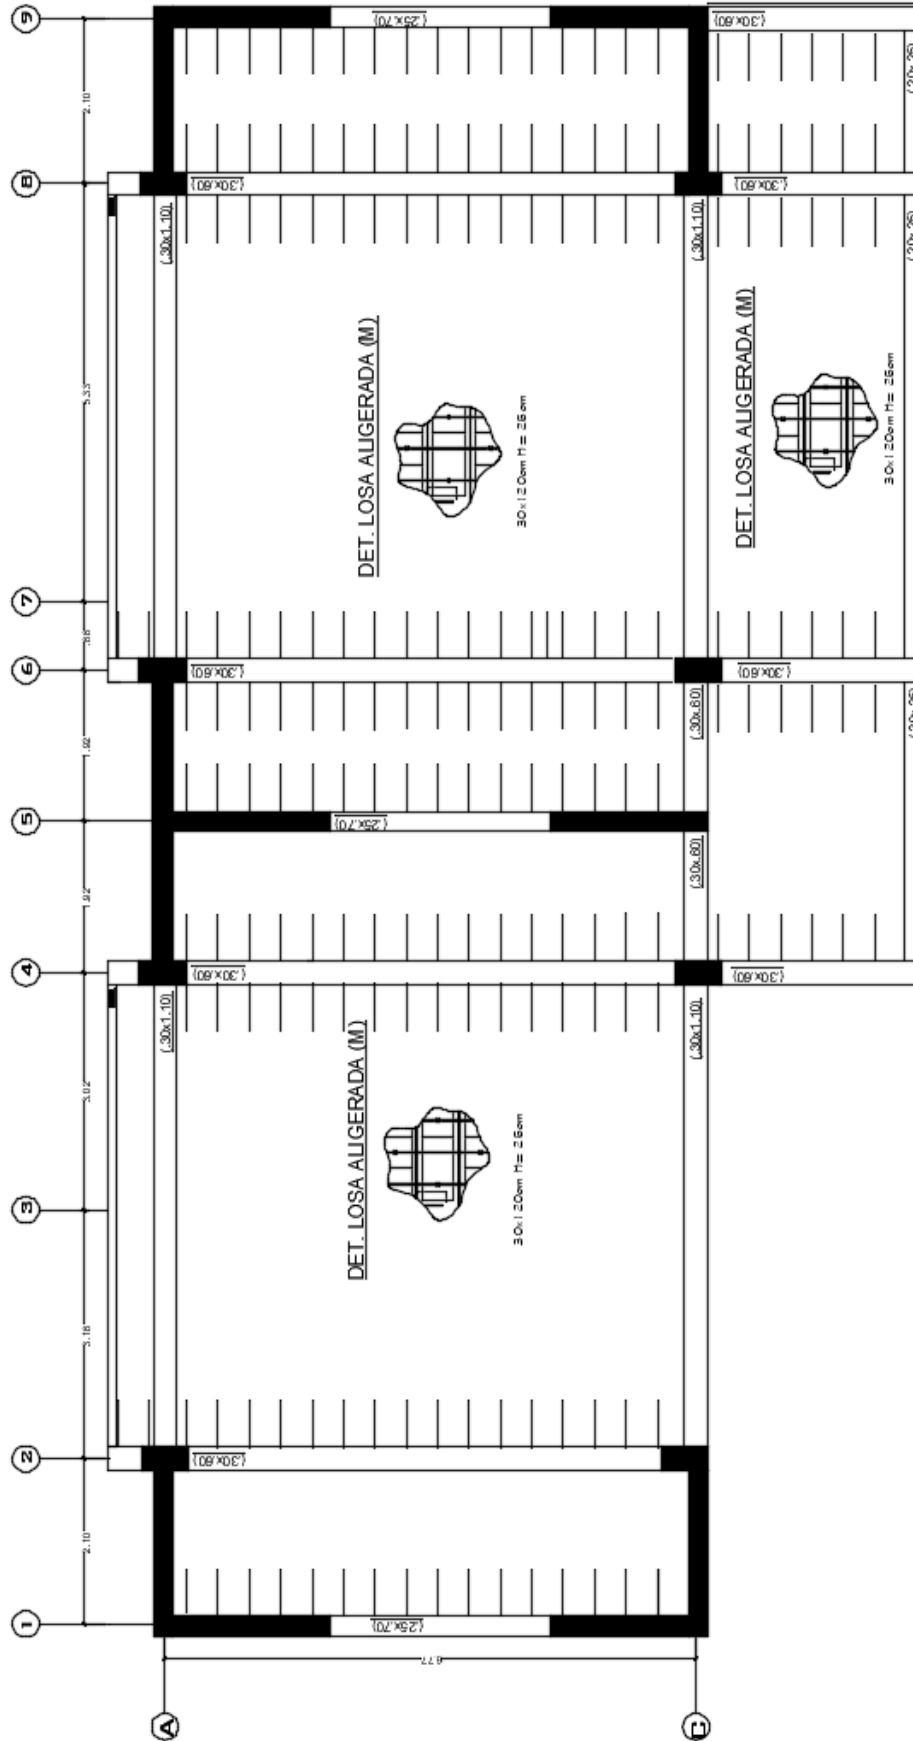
7.-Codificación de elementos estructurales para metrado de cargas
